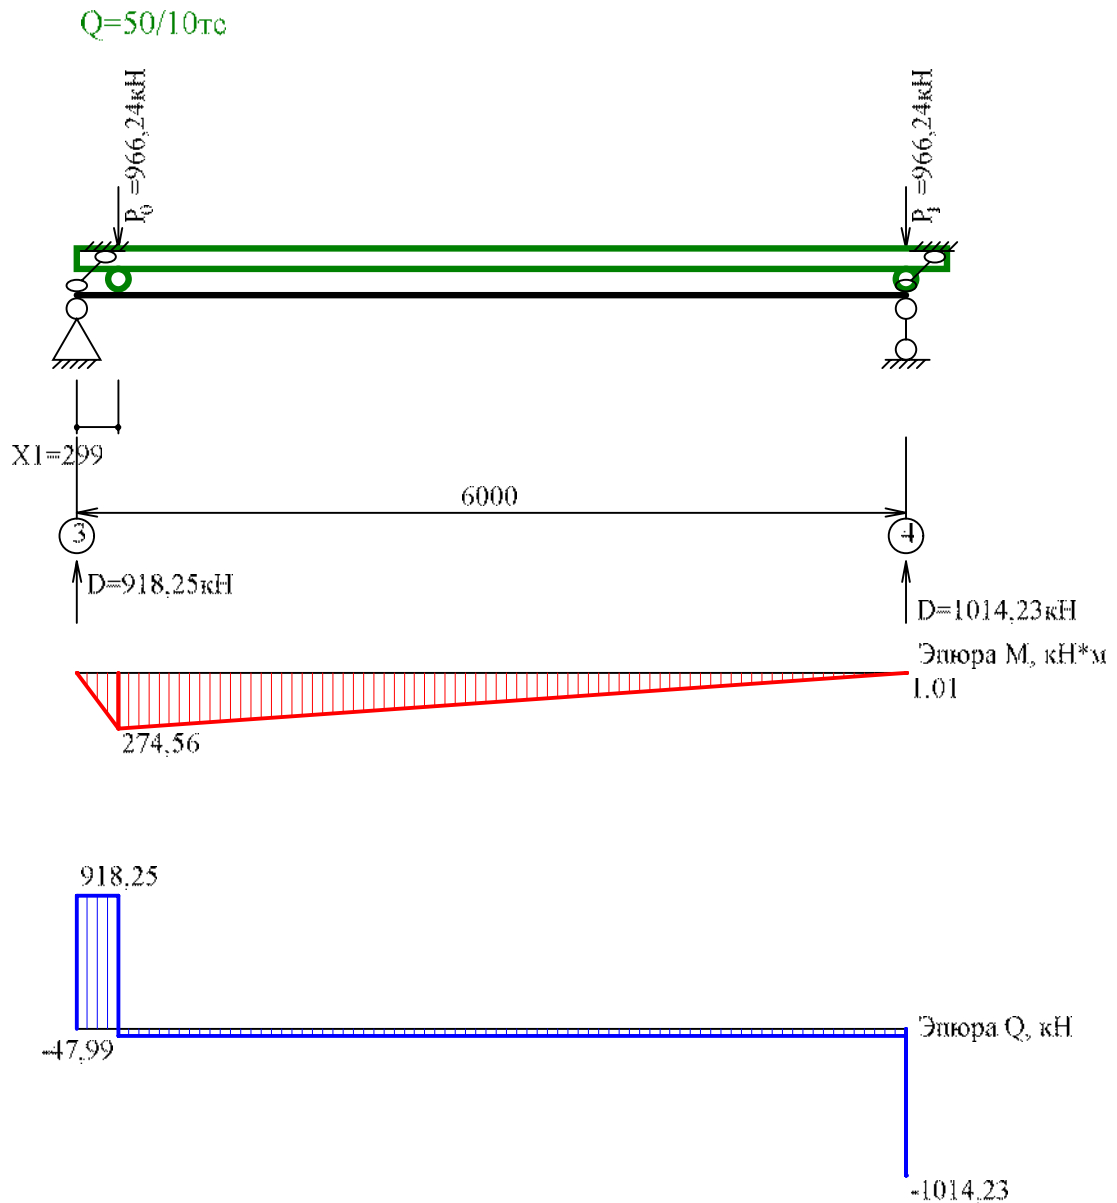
Эпюры усилий M и Q от вертикальной нагрузки при расчётном положении крана
